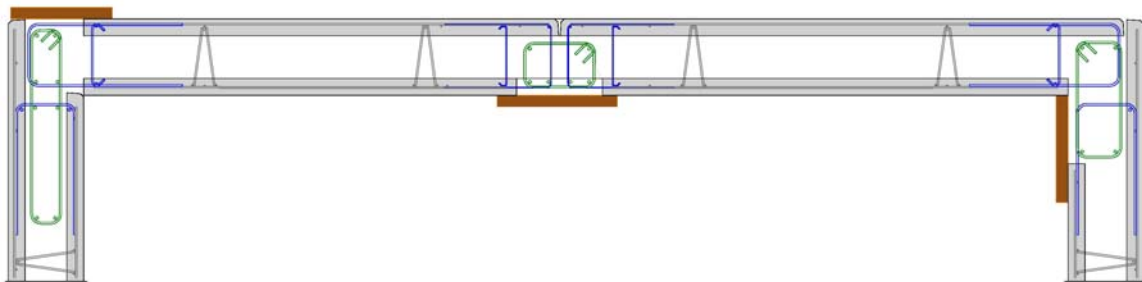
dispositions d'étanchéité par le béton seul, cas des Armacoffrés® posés après radier
